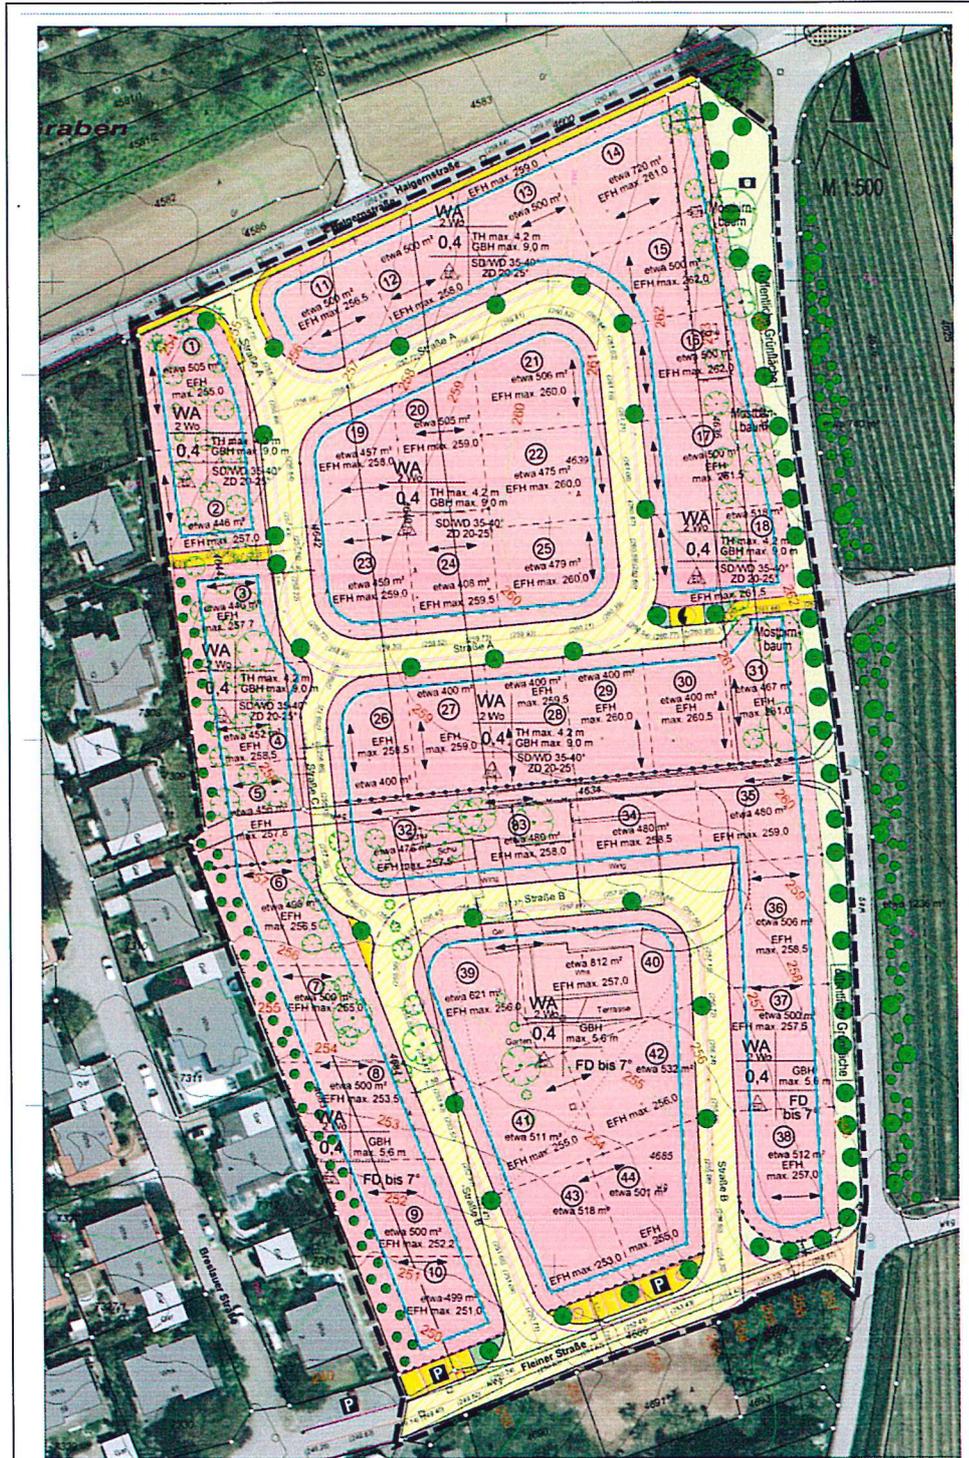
Bebauungsplan Entwurf 26.11.2018 (verkleinert)
